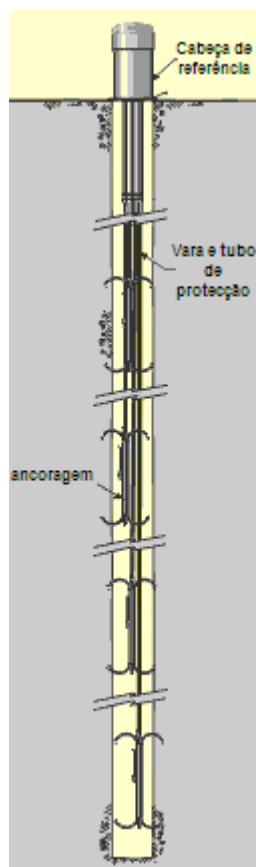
Extensômetro de fundação instalado num furo de sondagem (Slope Indicator, 2011)
